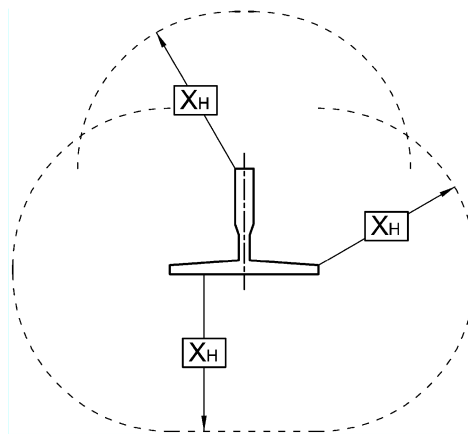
Horizontaler Abstand X_H zur Führungsschiene
